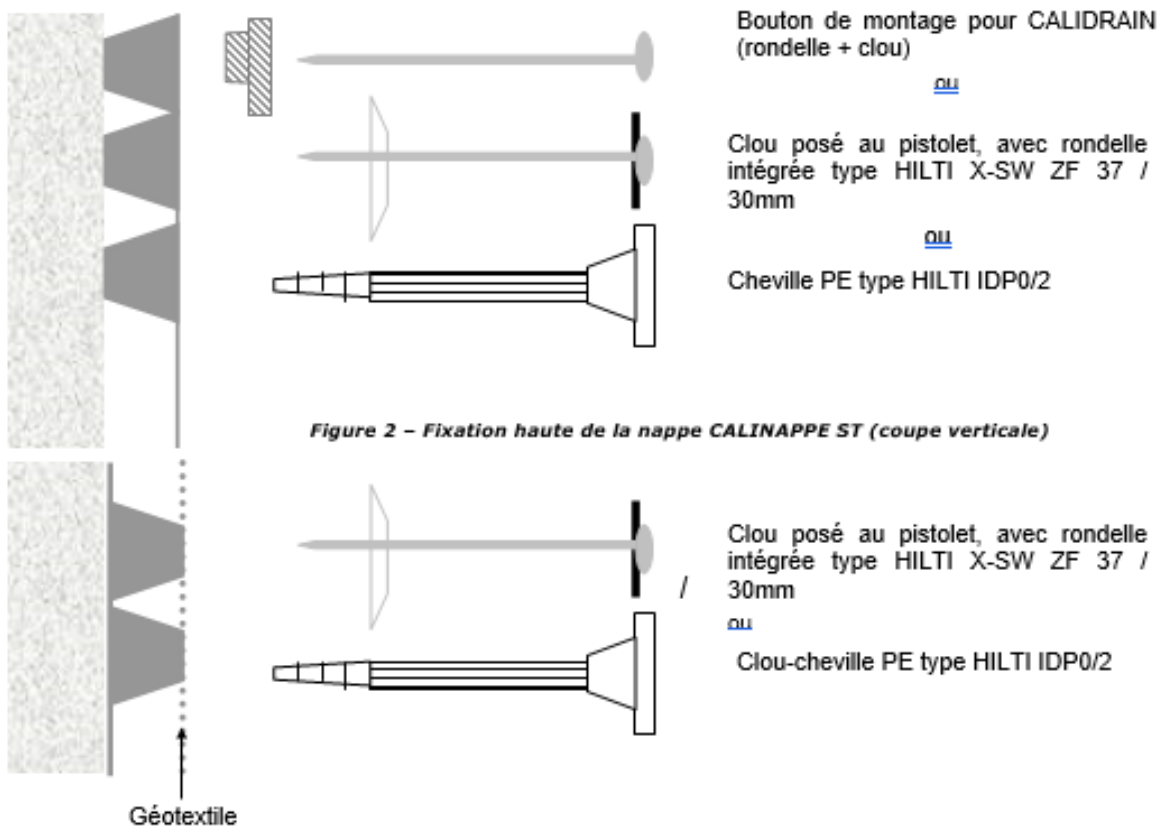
Fixation haute de la nappe CALIDRAIN TEC (coupe verticale)
